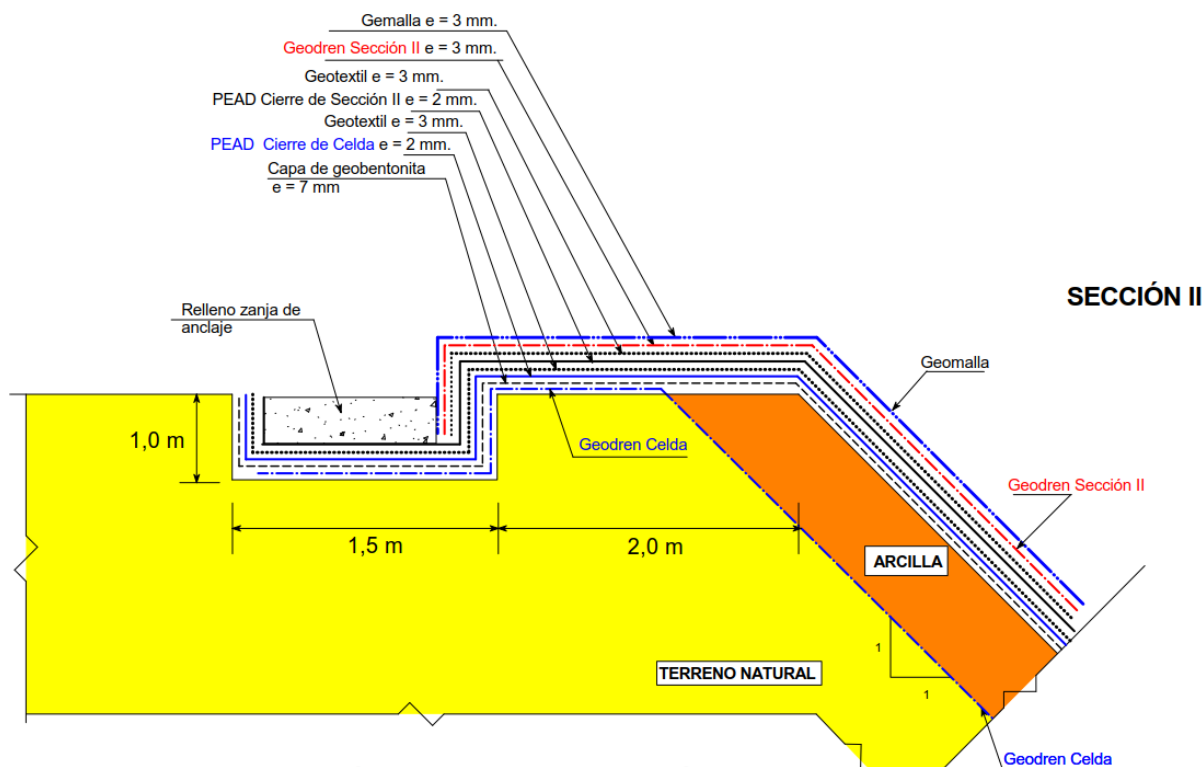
Sección tipo laminas protección que se anclan en zanja de anclaje.
